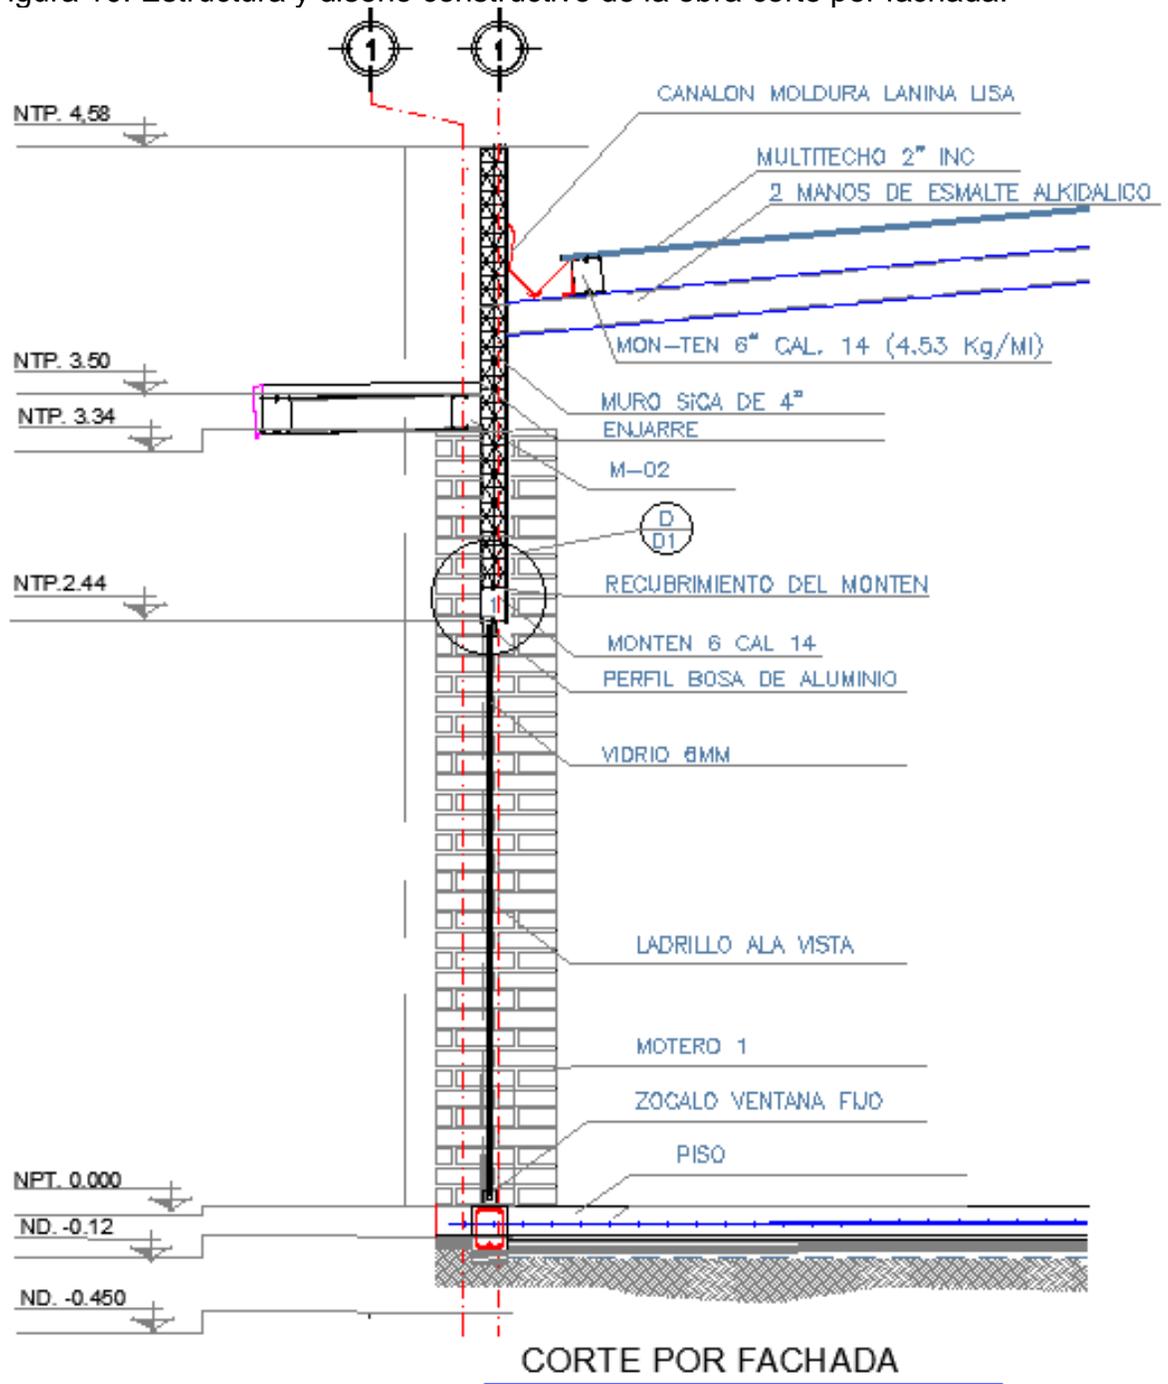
Estructura y diseño constructivo de la obra corte por fachada.
